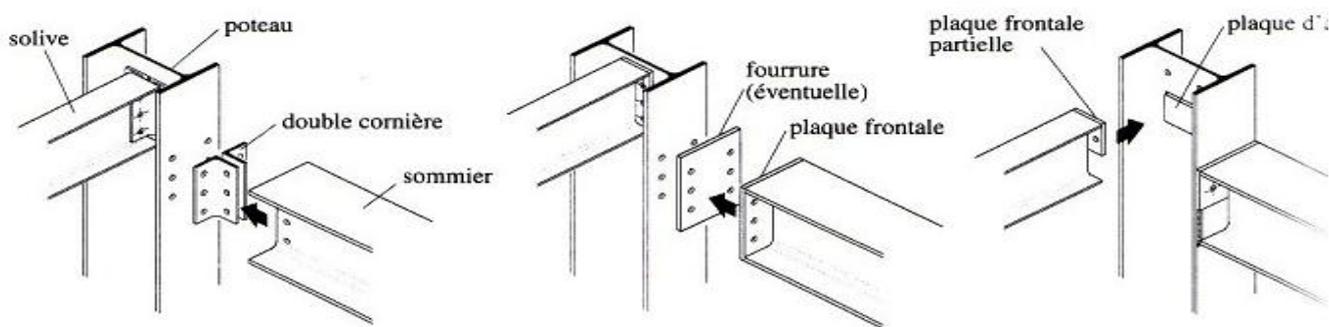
fixation du poutre poteau t poutre solive /source : et 231-liaisons-structure.pdf
